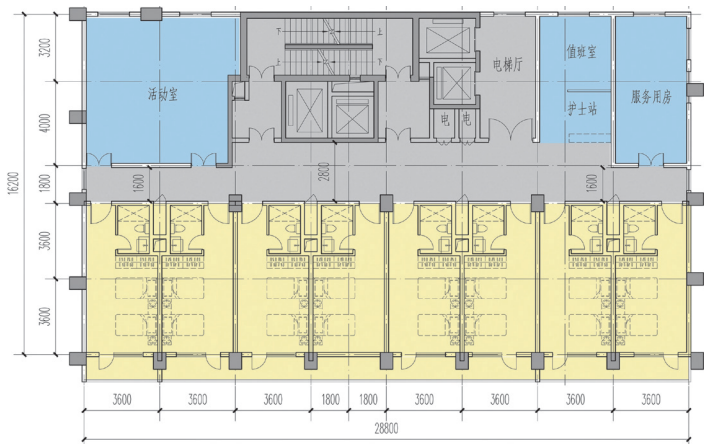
原规划的8#楼养老院标准层平面图（后全部改为养老公寓）
